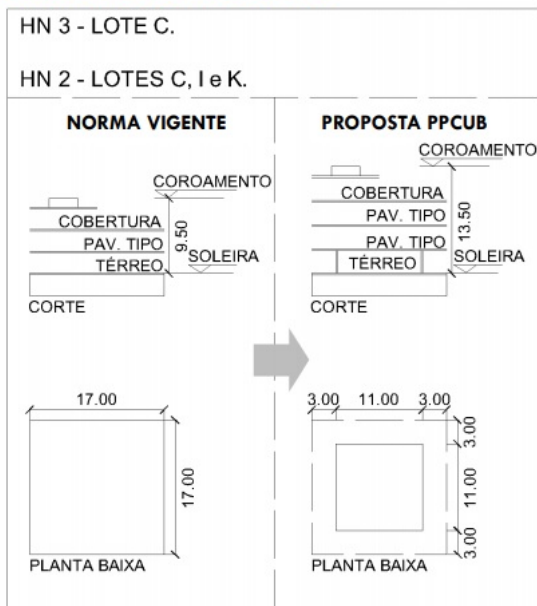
SHN/SHS, tipologia “bares/restaurantes”: proposta de alteração de gabarito, com acréscimo de 1 pavimento (de 3 para 4) e galeria no térreo
